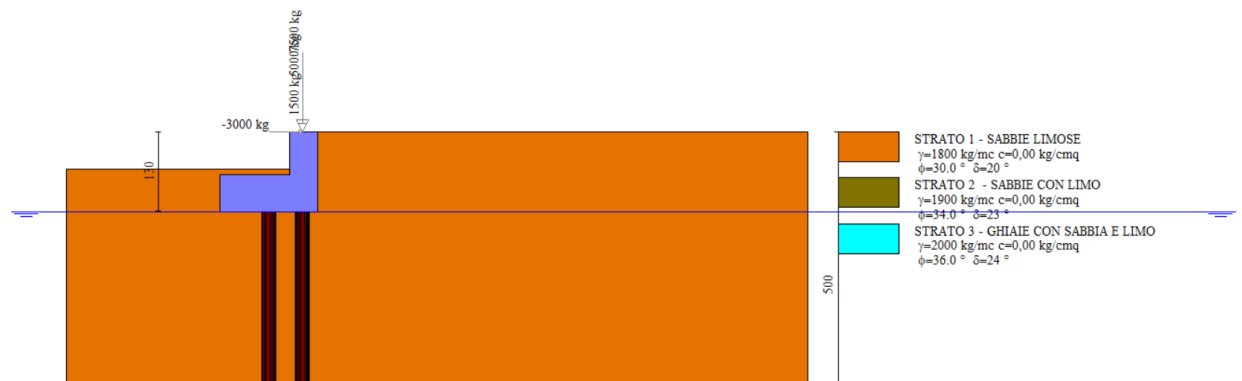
SCHEMA CARICHI MURO PARAGHIAIA E SPALLETTE
